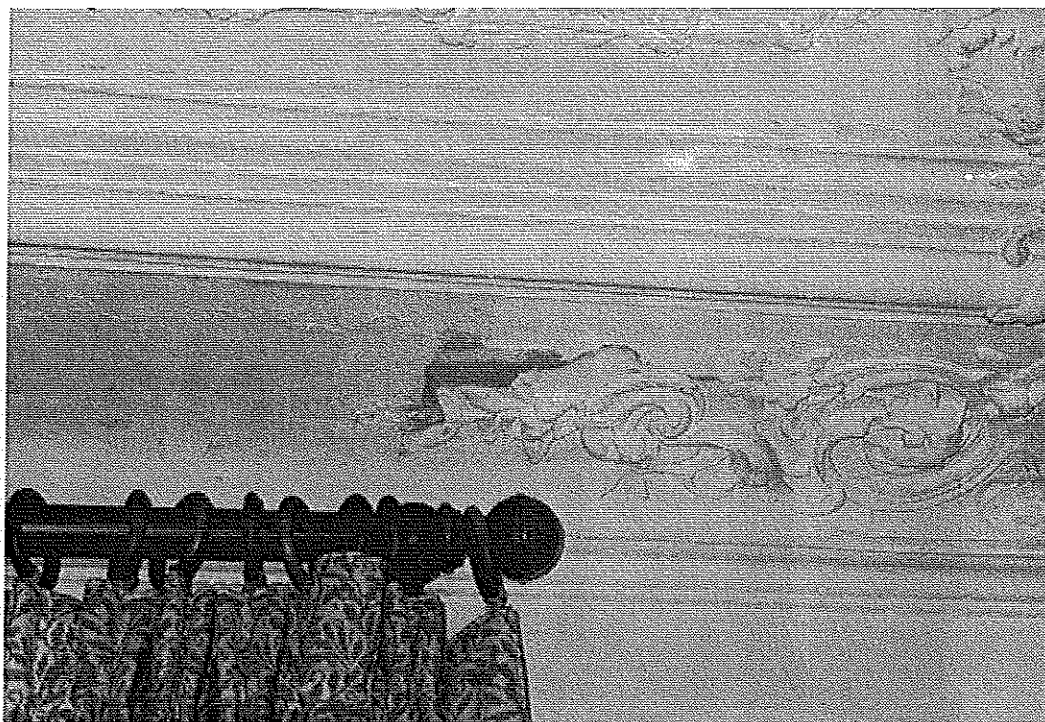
Désordres en plafond de l'étage sous-jacent, fissures, traces d'humidité. © J. Putatti
